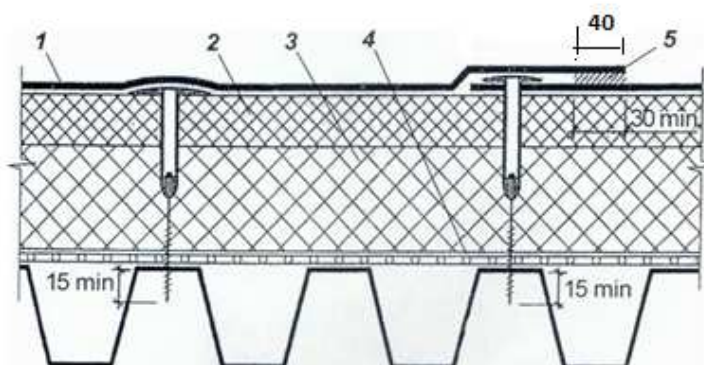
Схема крепления гидроизоляционного ковра из полимерных мембран и утеплителя к профилированному настилу
